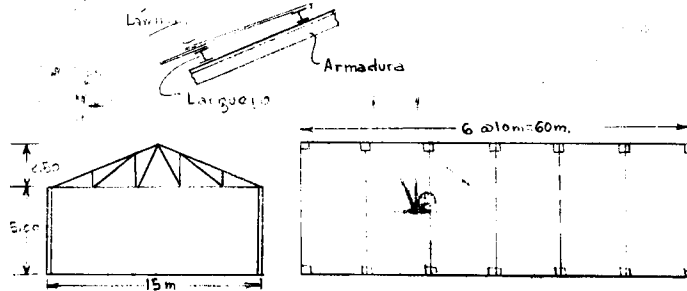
corte y planta de la estructura del ejemplo
